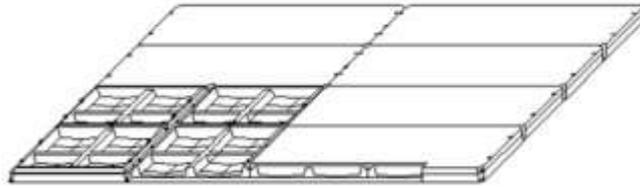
Пространственная железобетонная фундаментная платформа в сборном и сборно-монолитном вариантах для малоэтажного строительства в сложных грунтовых условиях. Патент РФ № 69094
